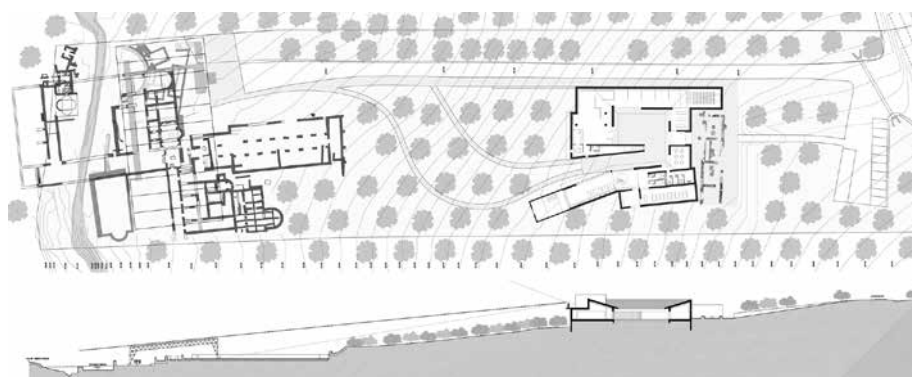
Planta general y sección. Plano sin escala. Arquitecto Ricardo Alario
